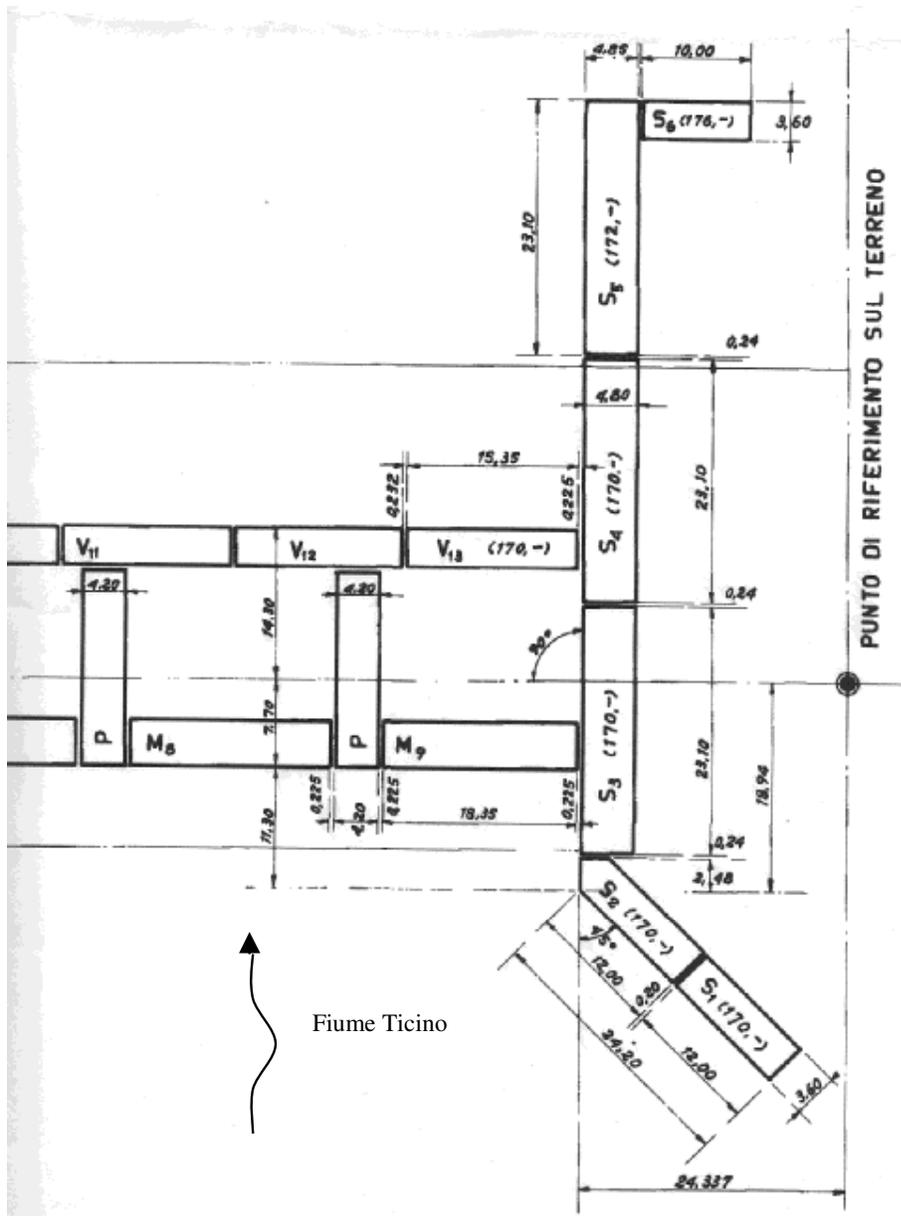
Atti di collaudo: Porto della Torre- Sbarramento: cassoni ad aria compressa – Planimetria dei cassoni della spalla destra.
